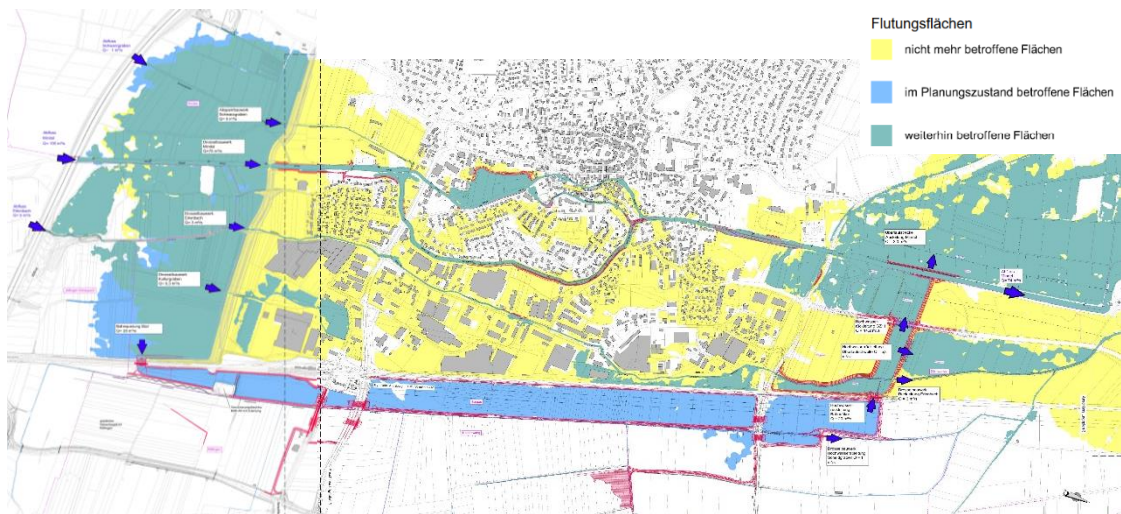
Lageplanausschnitt aus Anlage 3.7 der Genehmigungsplanung
